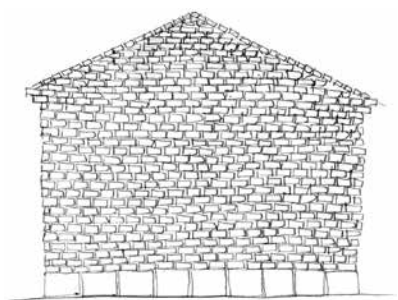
Sistema construtivo em alvenaria de tijolo_ Alçado tipo (Carvalho 2006)
